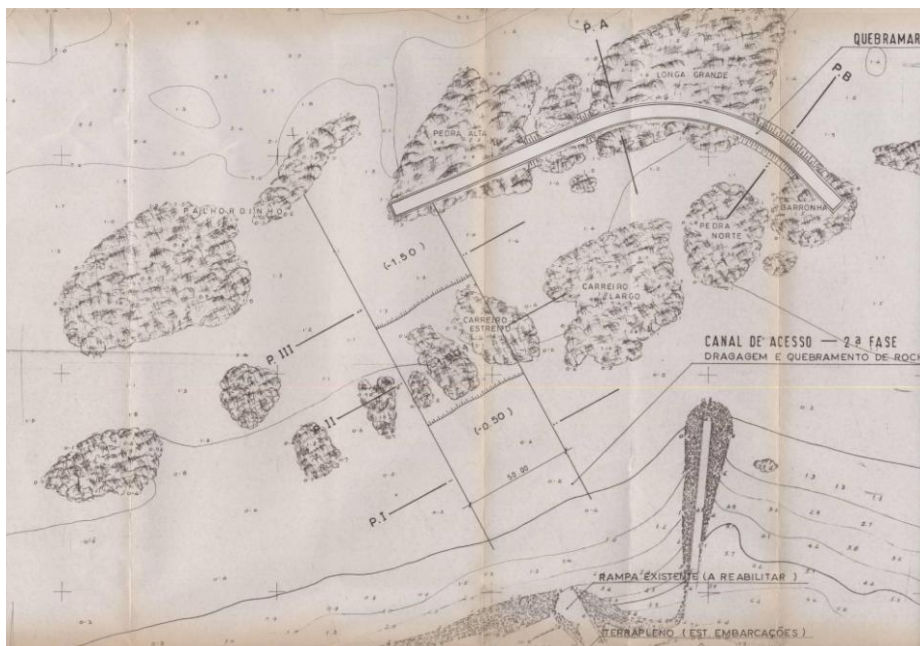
Planta do quebramar destacado da Pedra Alta. [2]
